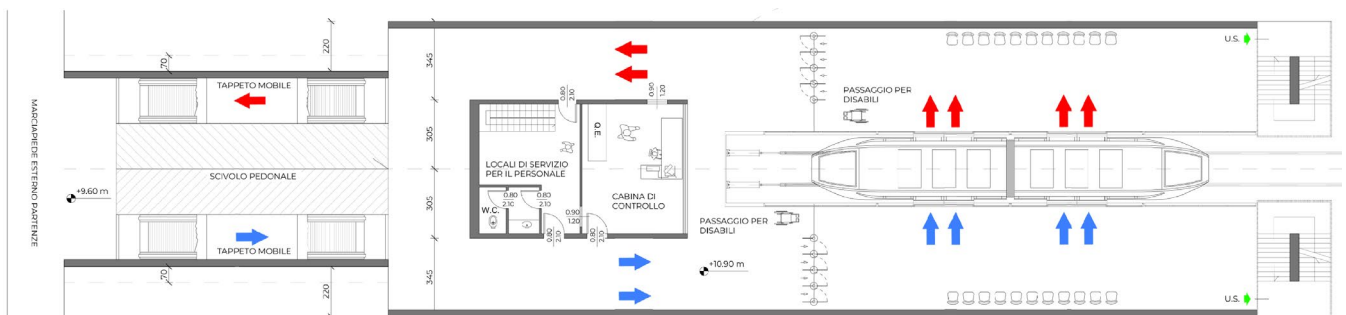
Pianta piano di imbarco/sbarco - stazione "Aeroporto"
